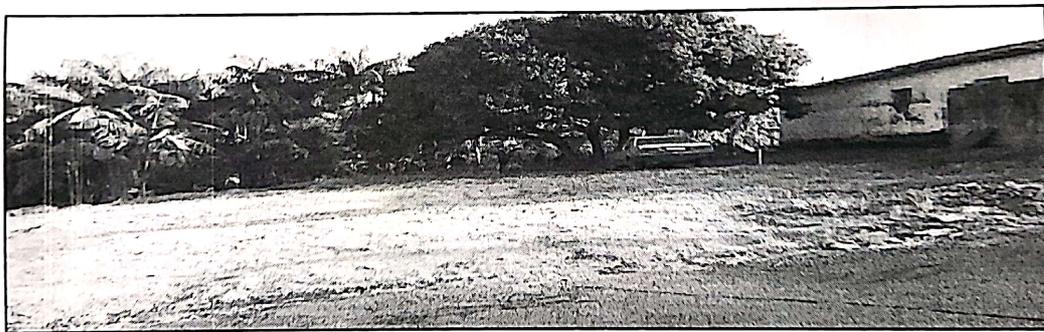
vista dos lotes 05, 06, 07 e 08 (fundos da casa)
